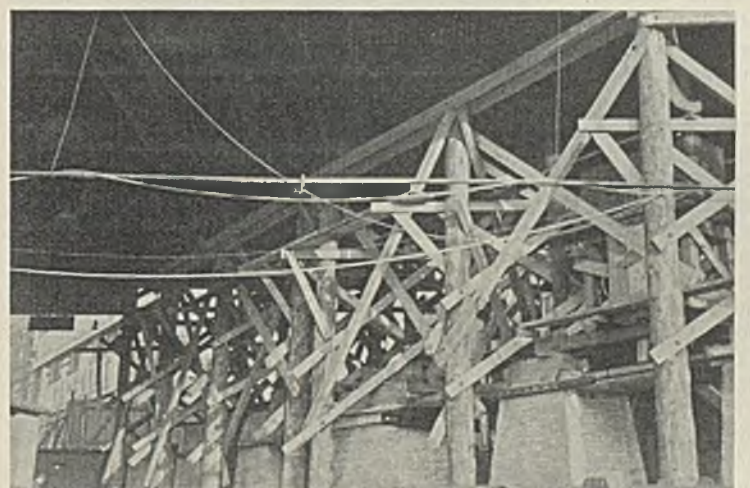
Vorübergehende Abstützung eiserner Überbauten vor dem Einbau der eisernen Abfangung.
